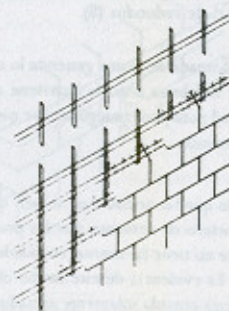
Armadura tipo al tridimensional para la fábrica armada
